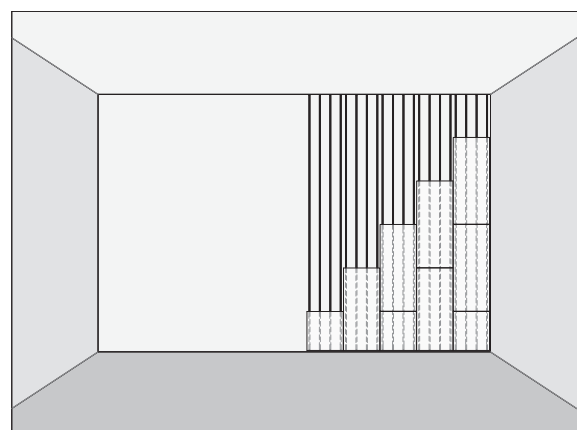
Montaż pierwszego elementu. Docięcie elementów brzegowych WALLDESIGN – montaż w pionie
